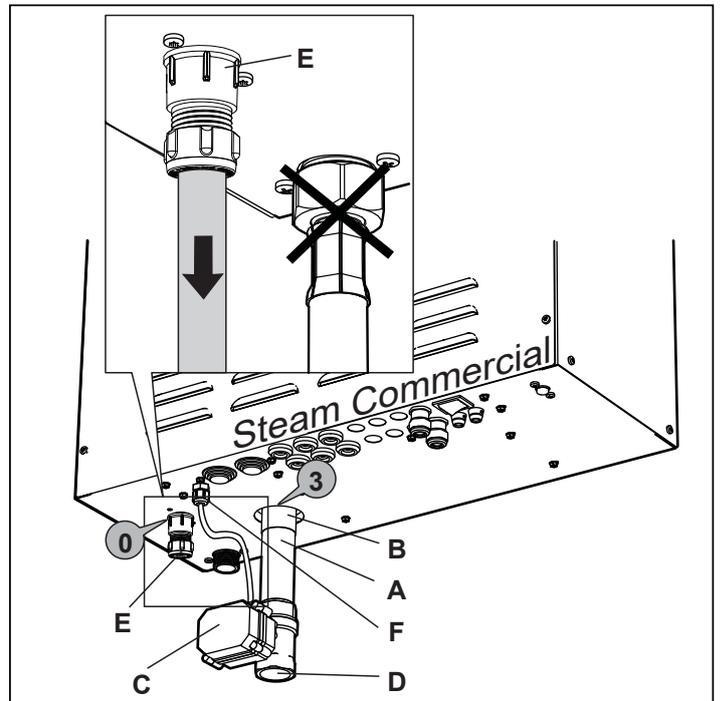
Ablaufanschluss des Dampferzeugers Steam Commercial
